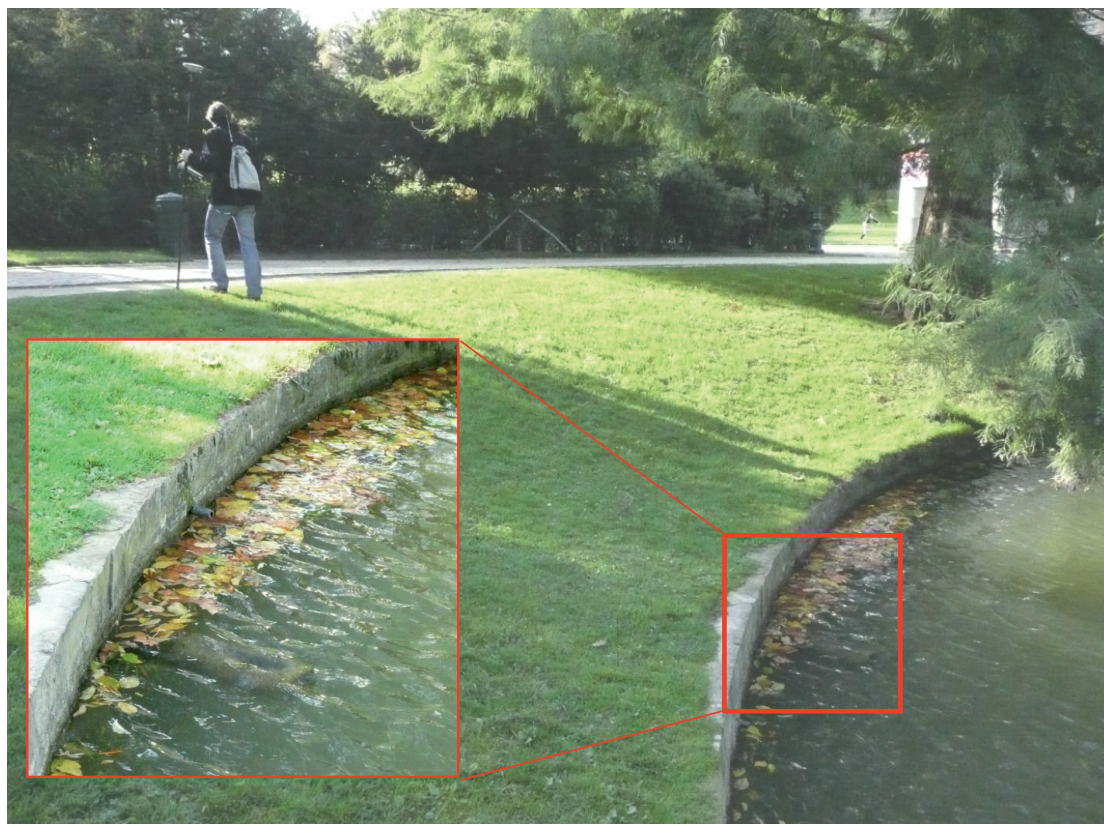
Localisation d'une ancienne conduite entre l'étang et le réseau d'égout
